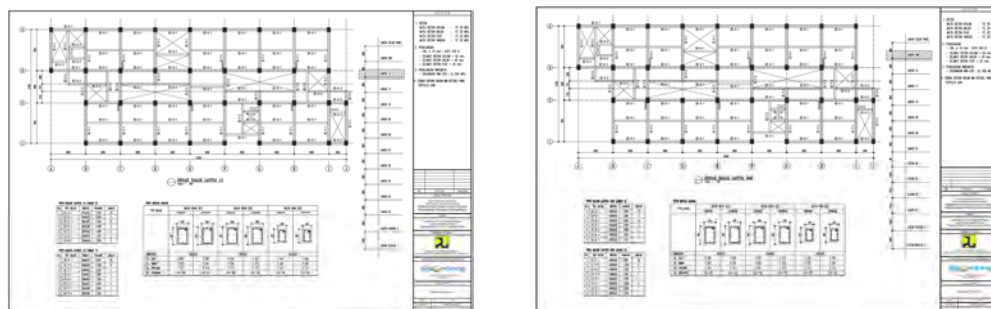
3 Detail struktur balok lantai 6 dan 7
